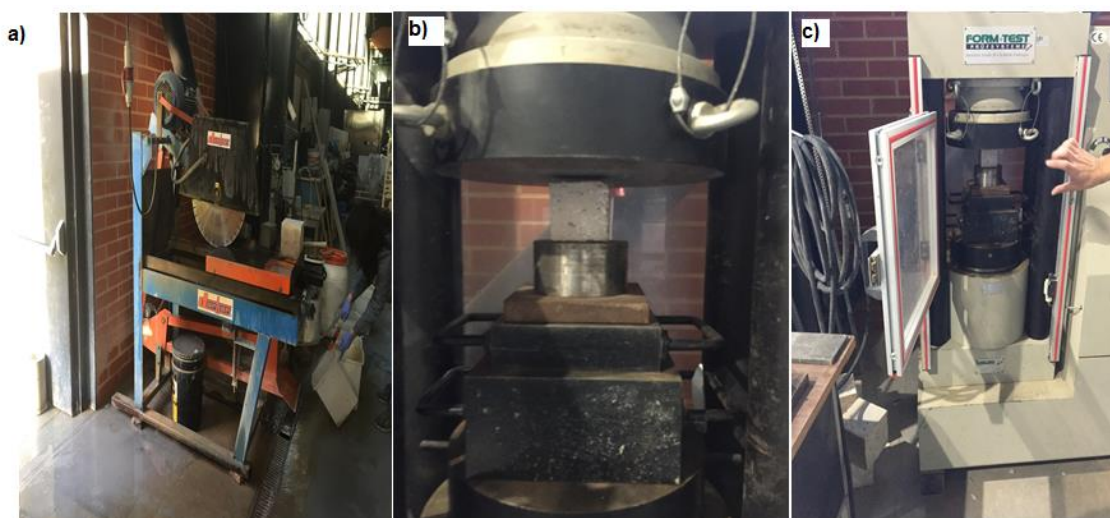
a) Máquina de corte. b) Provete cúbico na máquina de compressão. c) Máquina de compressão.
